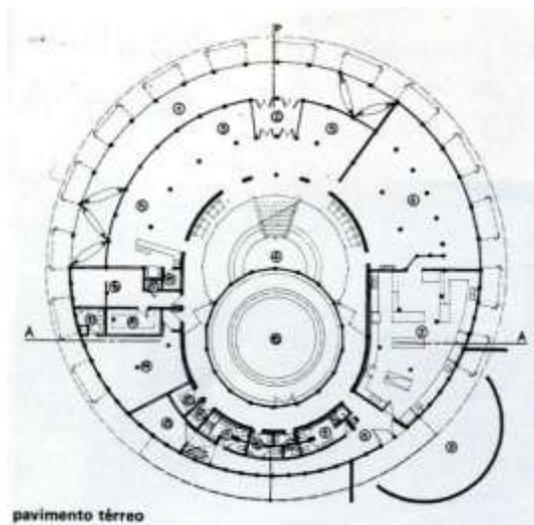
Planta baixa da Pousada da ilha de Silves, Severiano Porto, 1979-1983. Fonte: Revista AU n°81, dez-jan 1998, p. 44.
